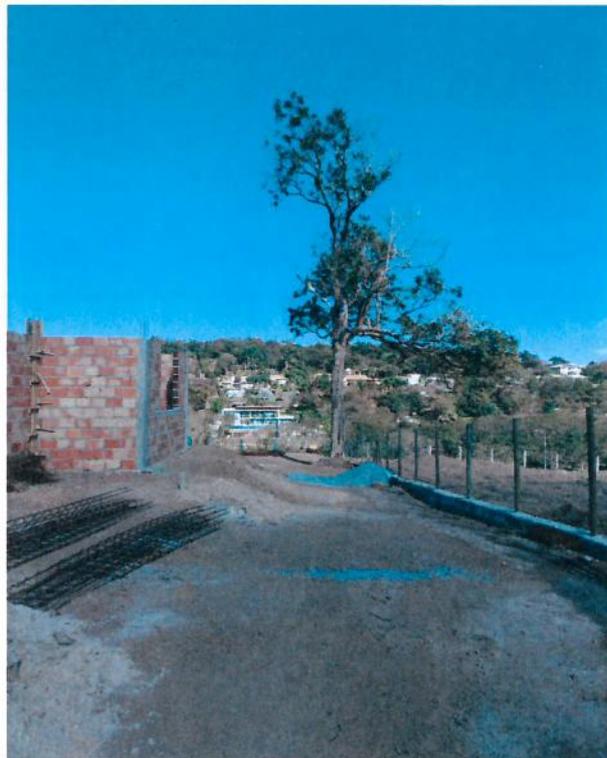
Ipê amarelo ao lado do imóvel em construção.
